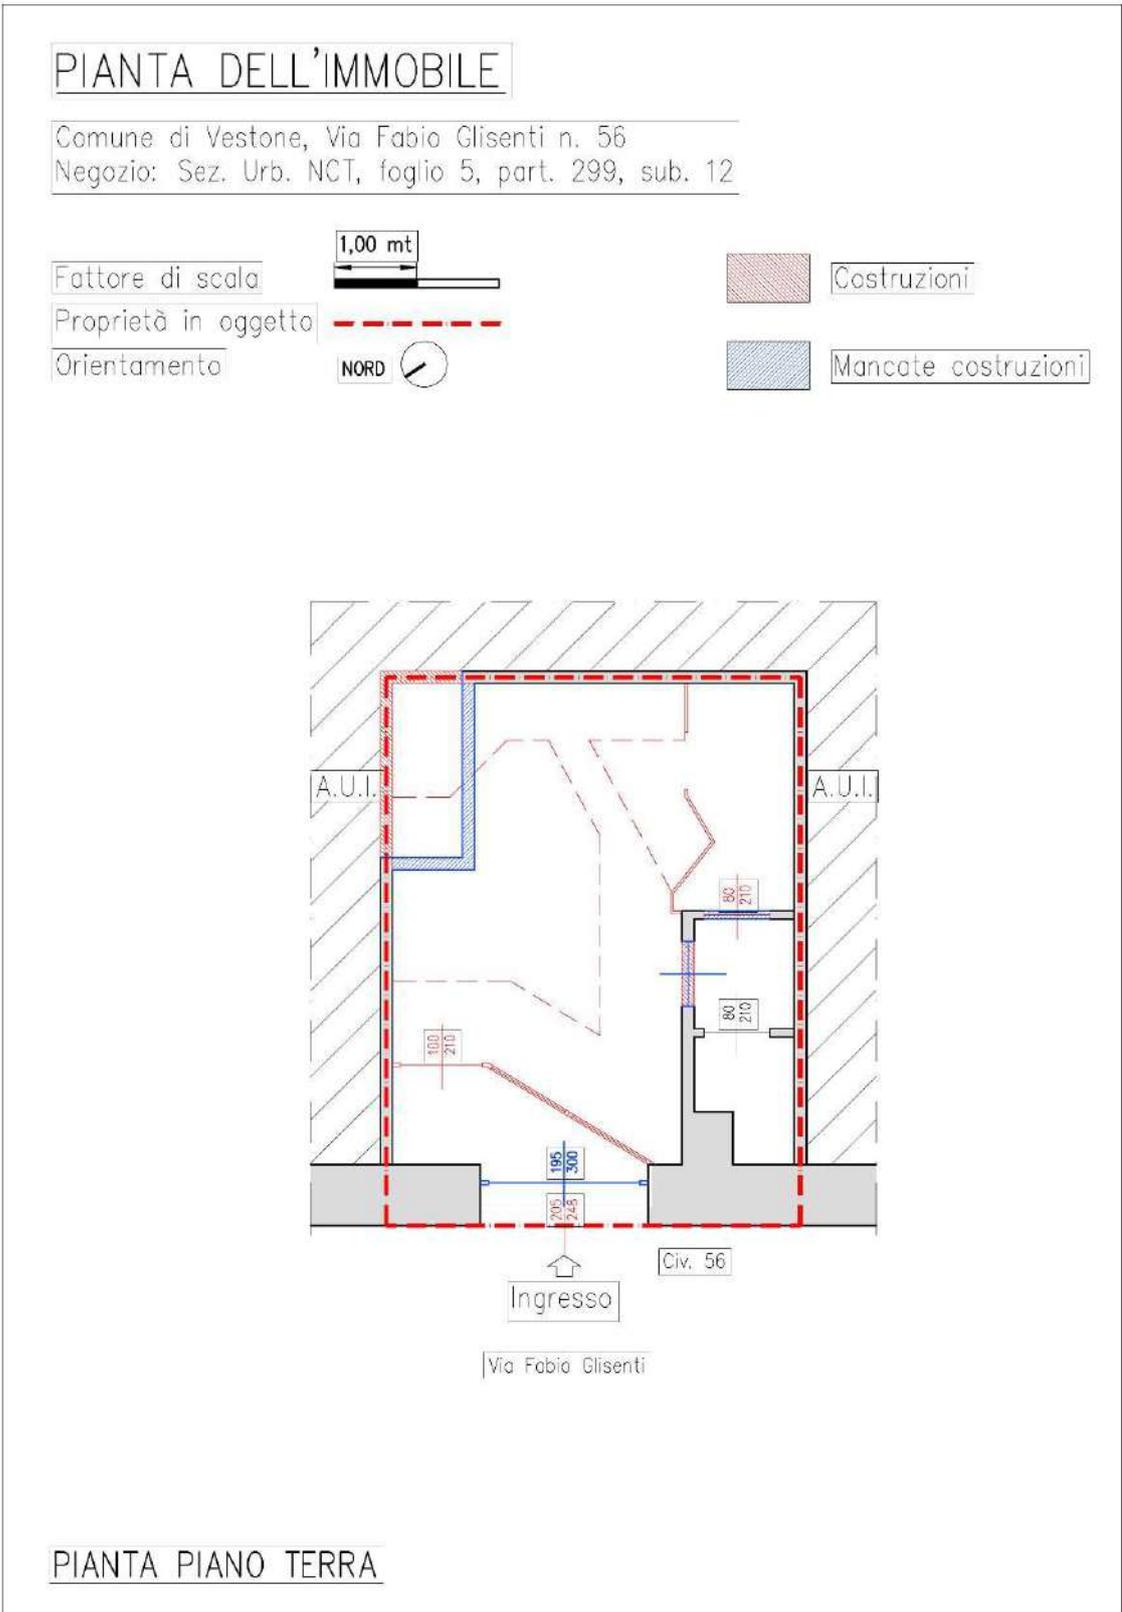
Pianta piano terra: confronto tra stato autorizzato e realizzato.
